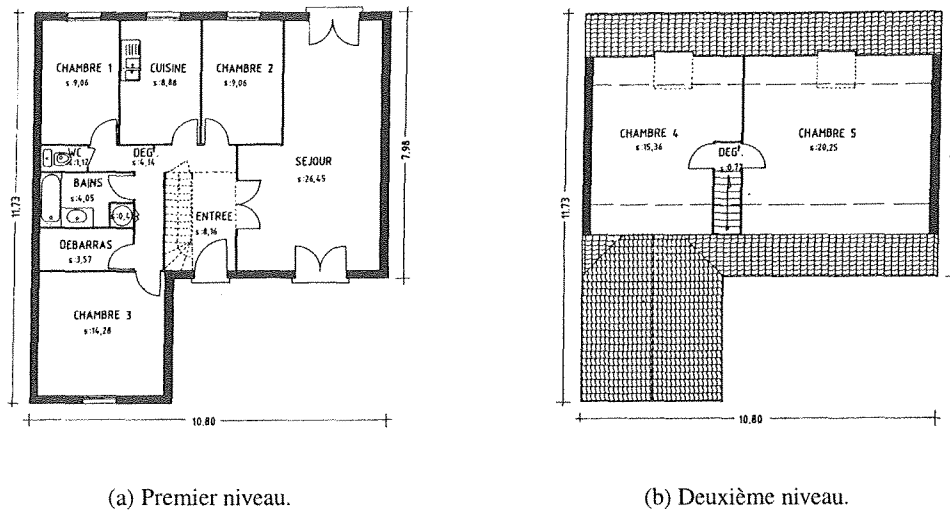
Plans architecturaux de deux niveaux d'un autre pavillon.
